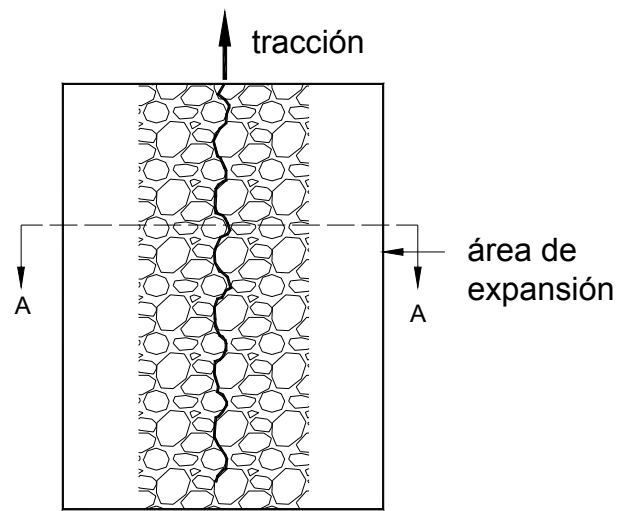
Anclajes de expansión de torque controlado y anclajes rebajados en la zona traccionada fisurada de una losa de hormigón (Eligehausen, Fuchs, Lotzew y Reuter, 1989)
